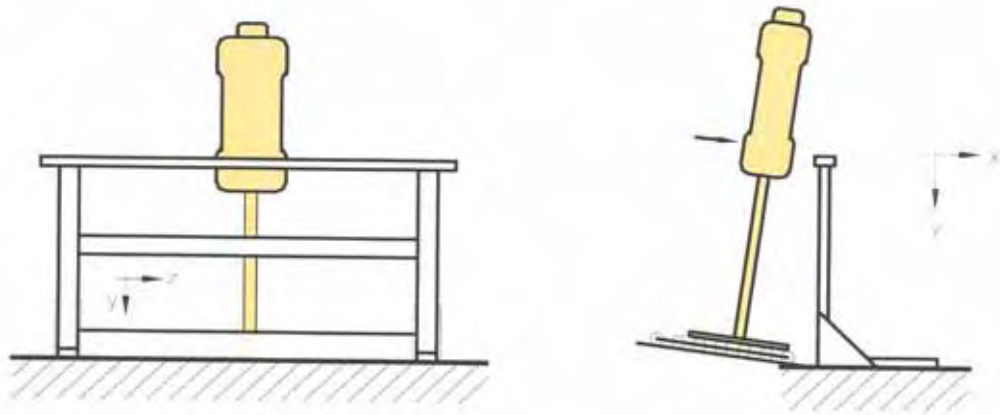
Essais dynamiques sur la lisse supérieure d’une section de garde-corps ancrée au parapet.
